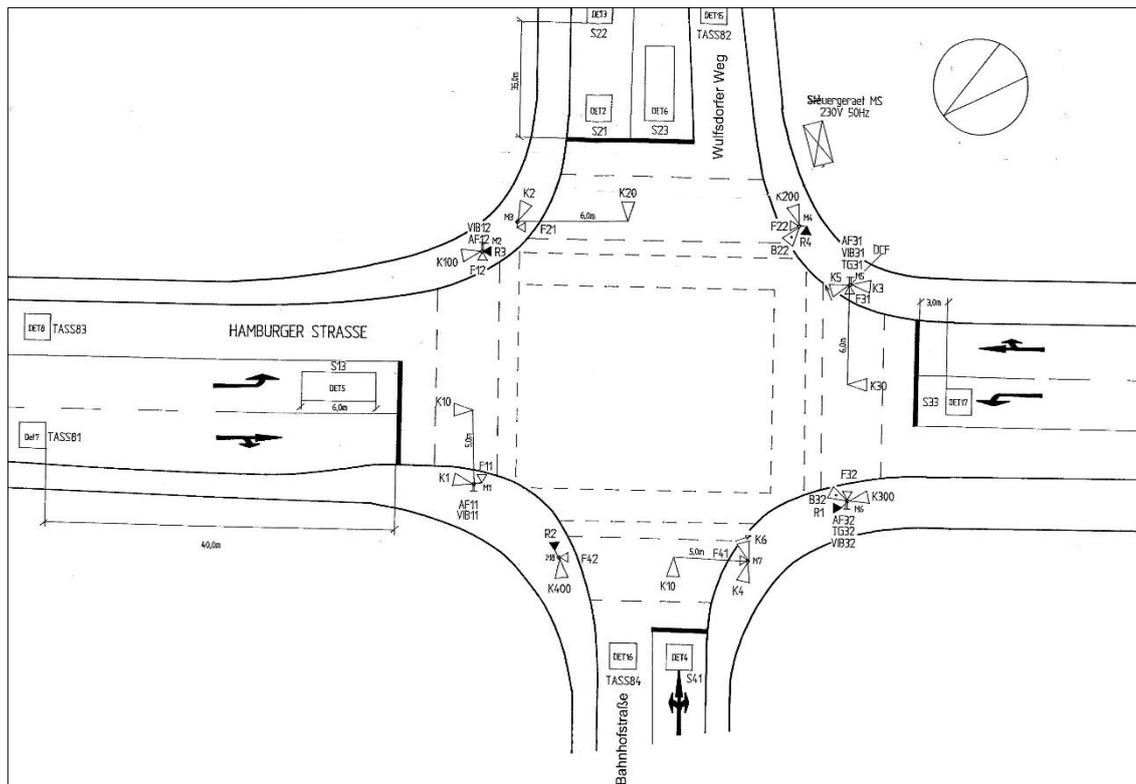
Knotenpunkt Hamburger Straße/Bahnhofstraße – Signallageplan
